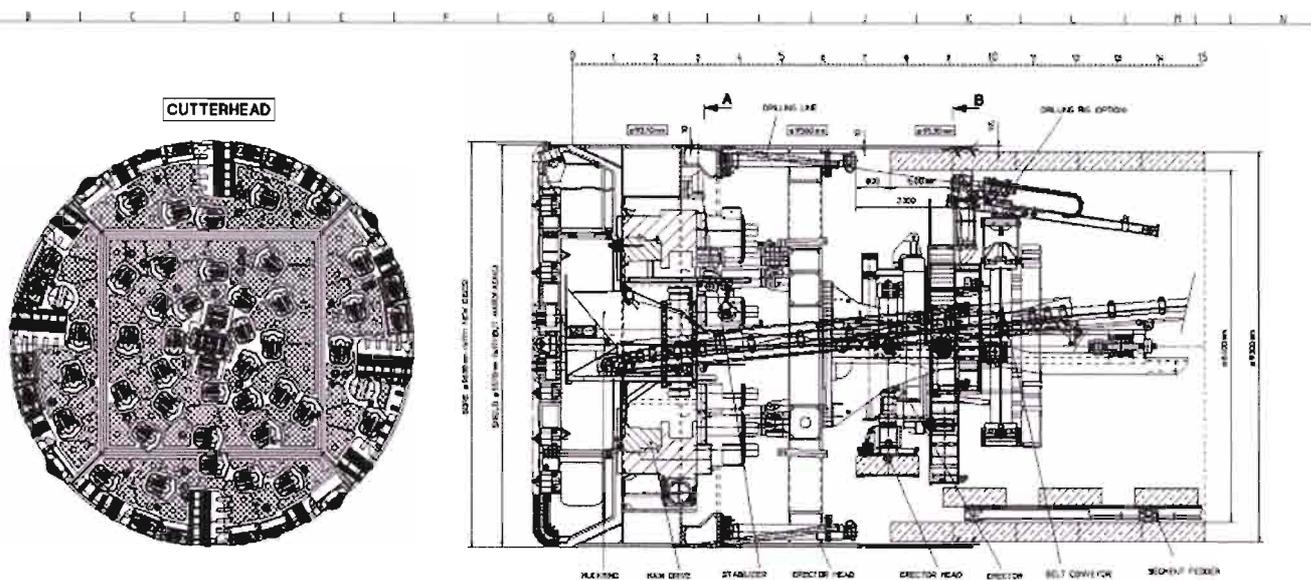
TBM scudata da roccia - Testa fresante e sezione longitudinale scudo
